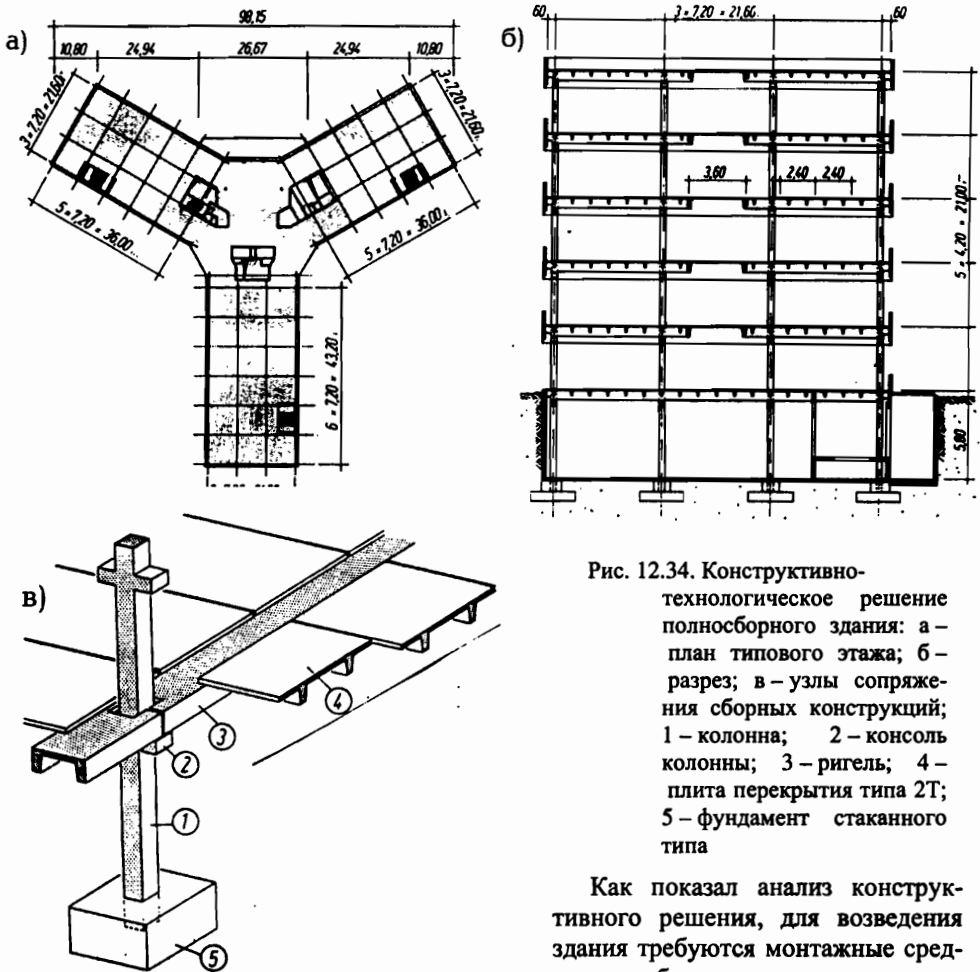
Конструктивно-технологическое решение полносборного здания: а – план типового этажа; б – разрез; в – узлы сопряжения сборных конструкций; 1 – колонна; 2 – консоль колонны; 3 – ригель; 4 – плита перекрытия типа 2Т; 5 – фундамент стаканного типа
